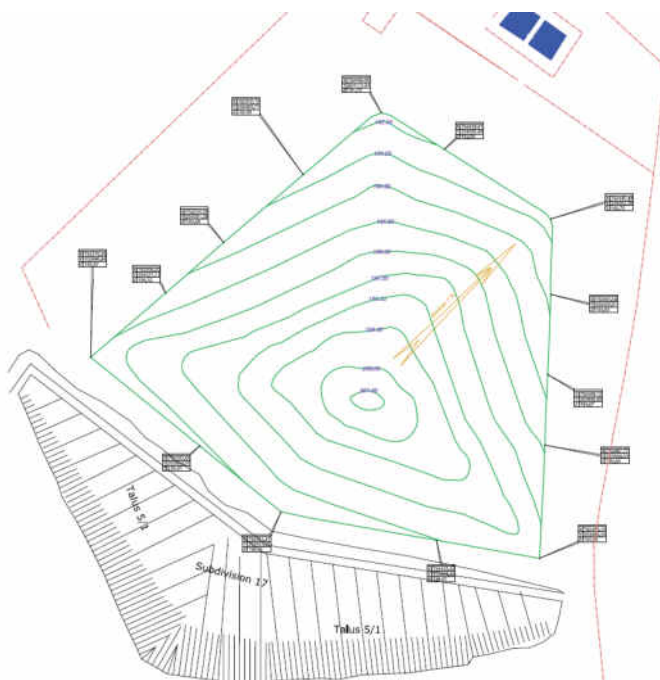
A : Plan des subdivisions – Plan de réaménagement (source : KALIES, 2017)
